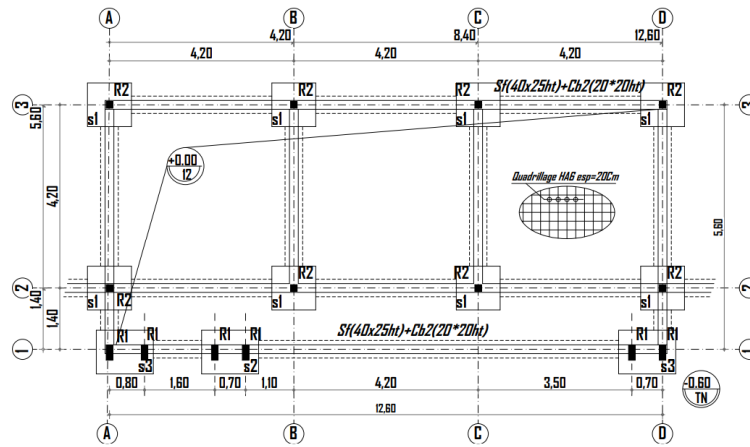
Exemple d'une coupe et plan du 1<sup>er</sup> étage.
